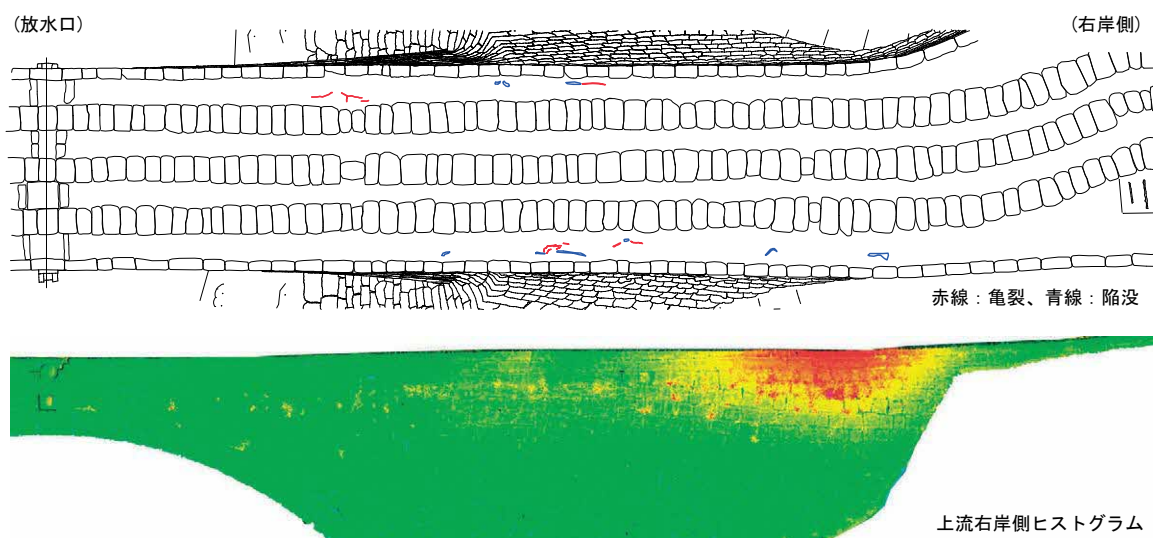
叩き層のひび割れと陥没範囲
